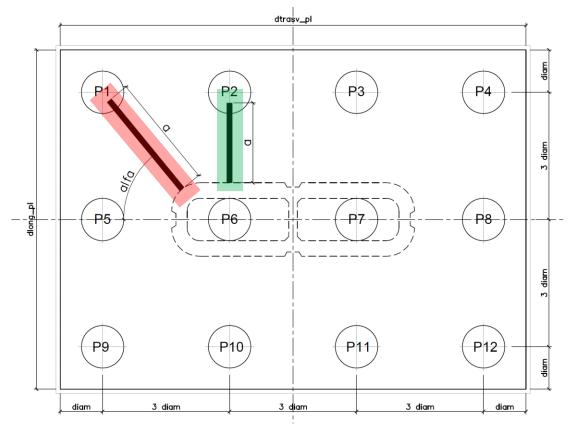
Vista in pianta - Tirante-puntone longitudinale (verde) e diagonale (rosso) –  $\alpha$  = 51°
